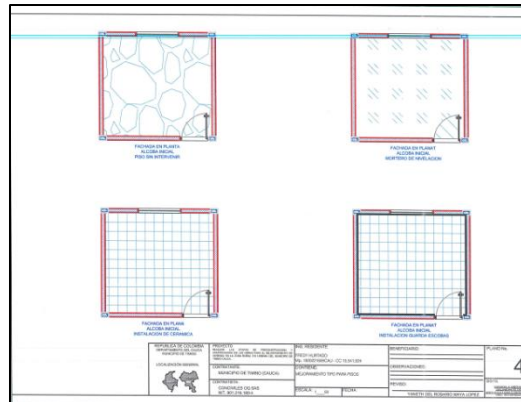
Plano Mantenimiento tipo para Pisos (Fuente CONCIVILES OQ SAS)
